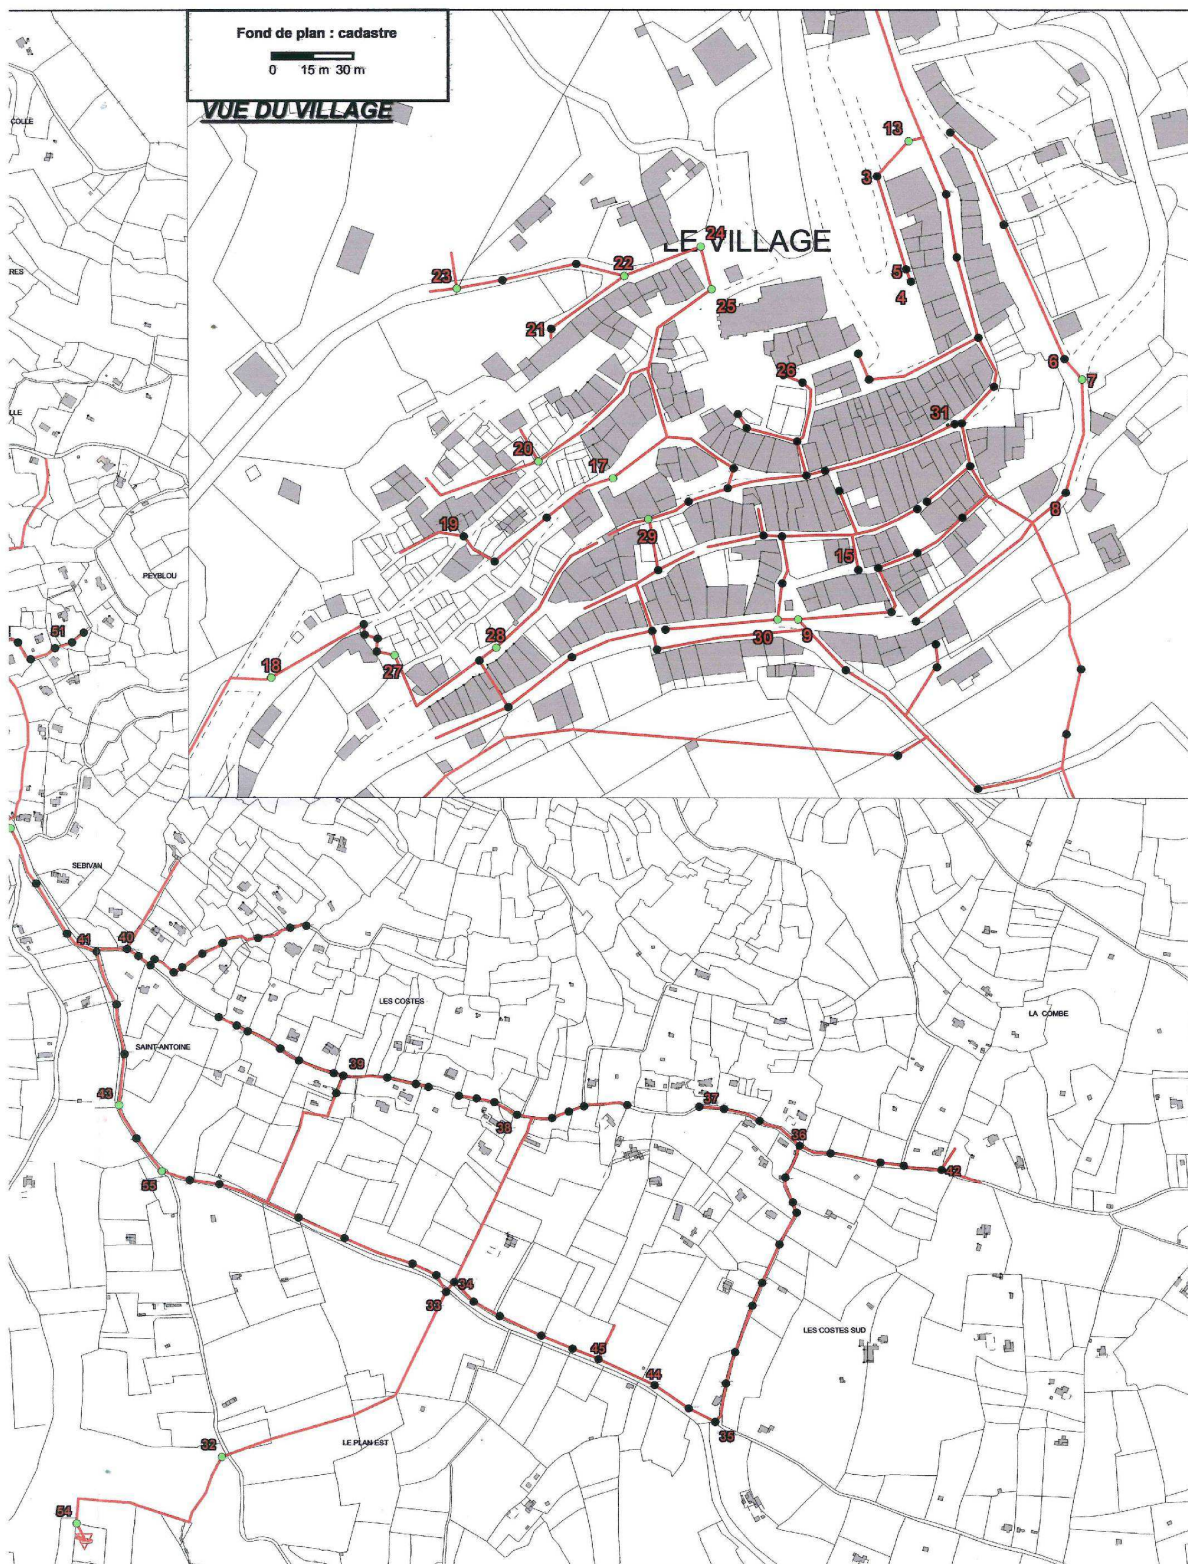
plan de localisation des anomalies sur le réseau d'assainissement 2/2
